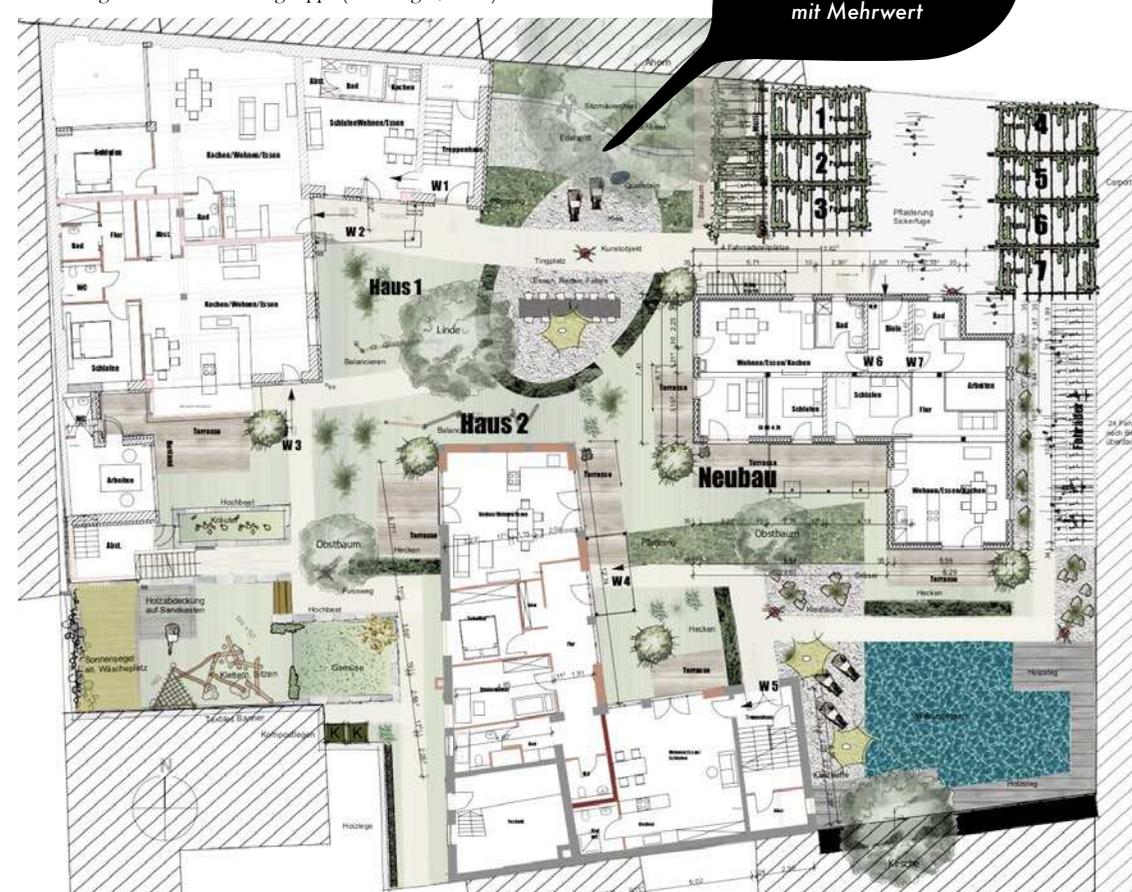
Grundriss Erdgeschoss mit Freiraumgestaltung (Weidinger, 2014)
